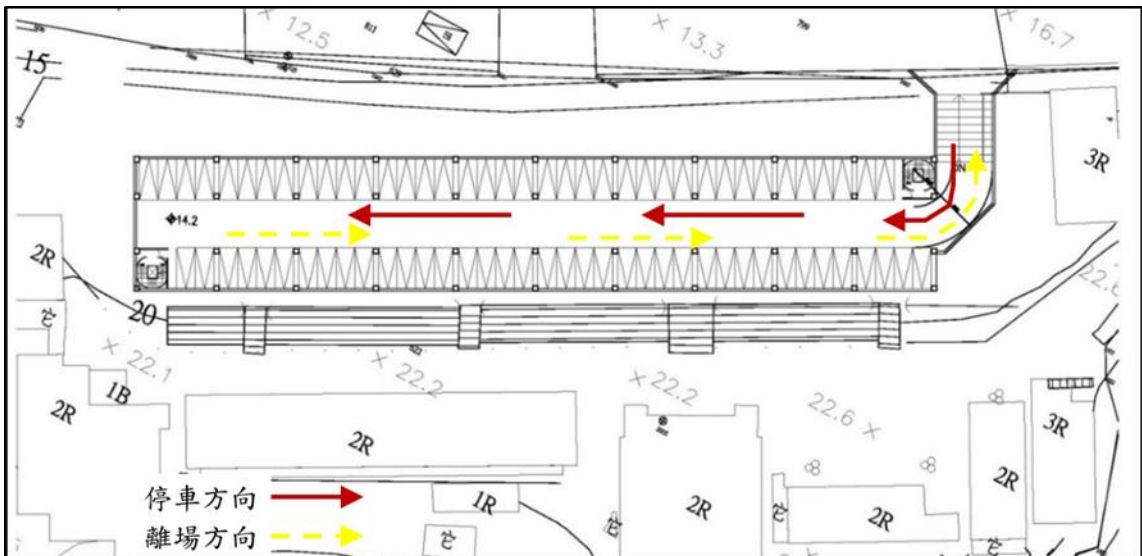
南竿中正國中公共地下停車場(B1)平面圖
